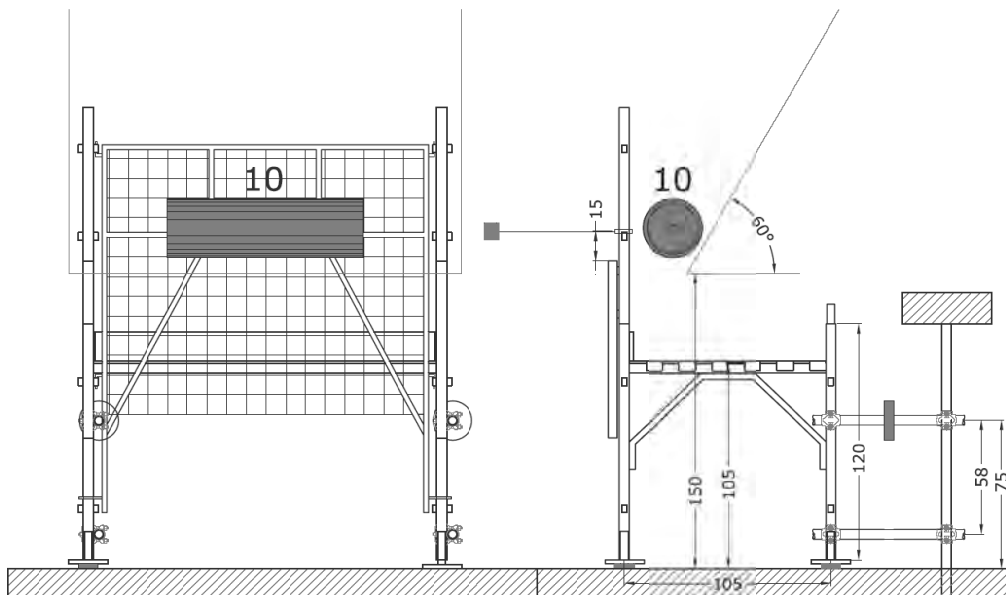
Prova d'impatto con rullo cilindrico su protezione continua (rete) - Schema CSR
